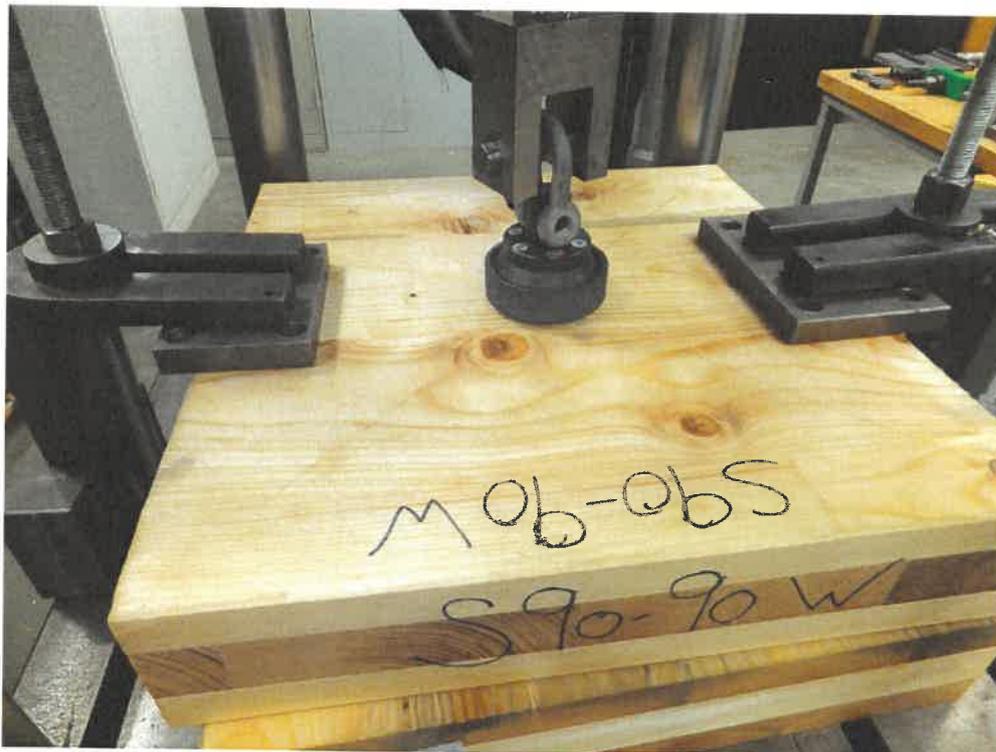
Versuchsaufbau bei Belastungsrichtung senkrecht zur Plattenebene
